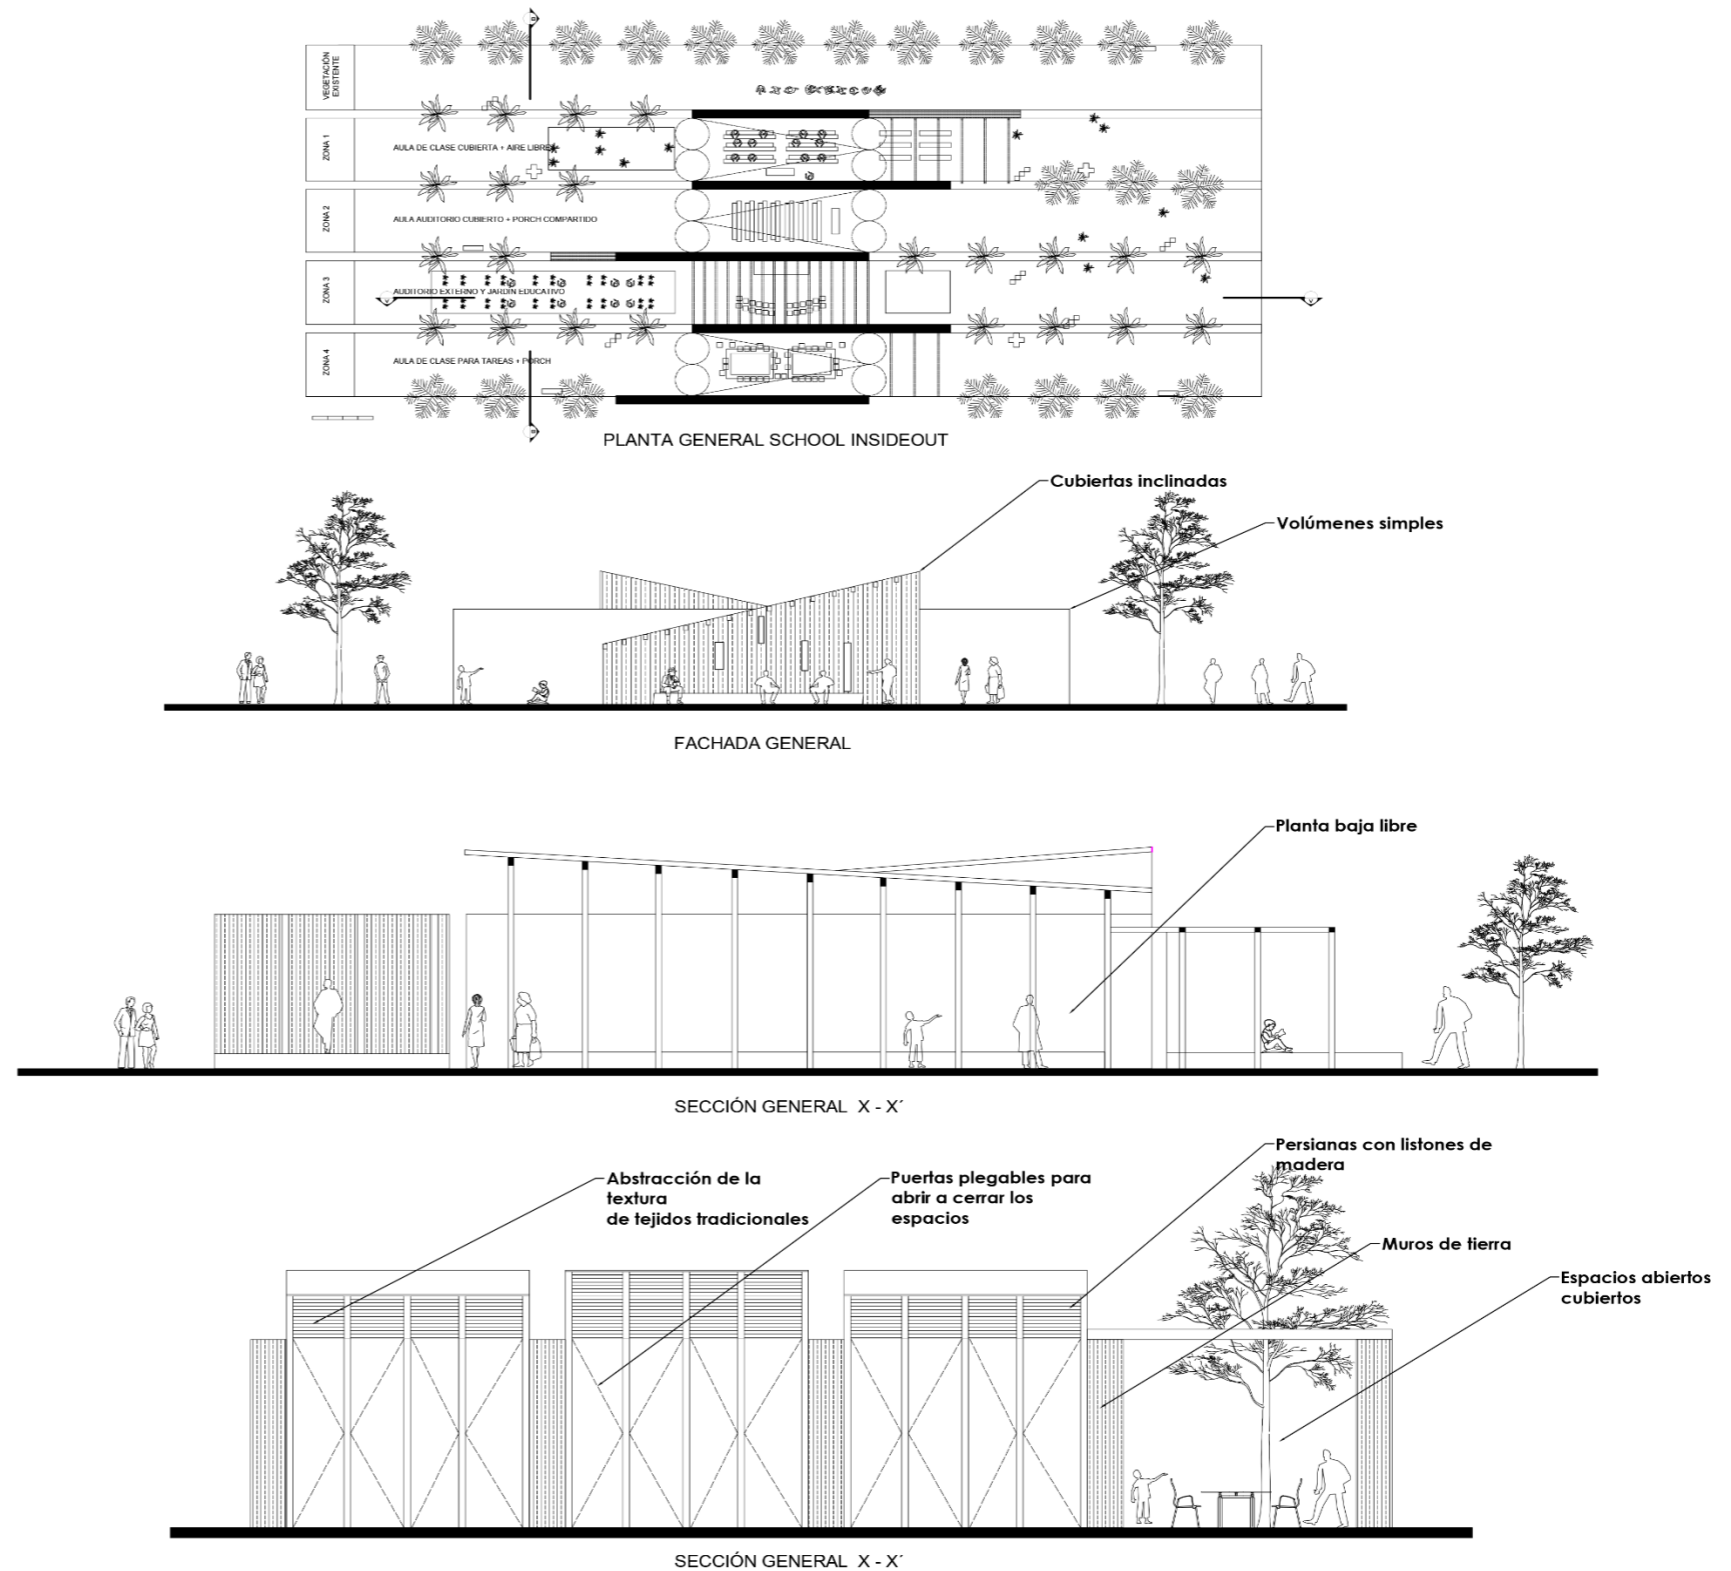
Planta general, fachada y secciones de escuela InsideOut.
